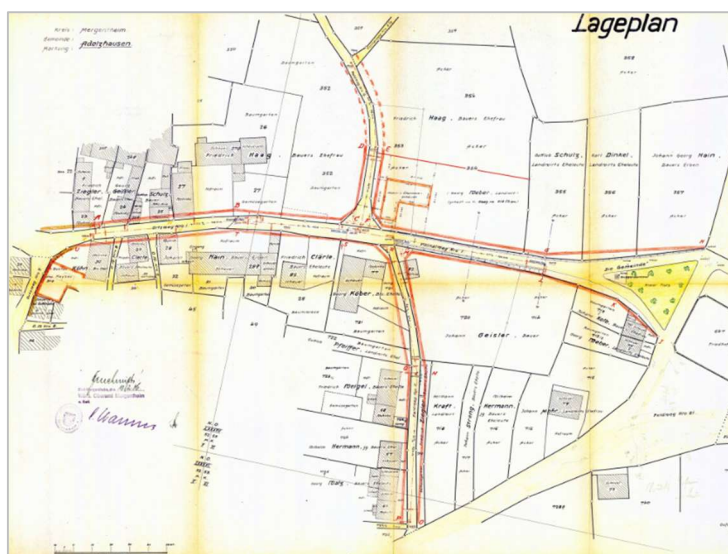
Lageplan Bebauungsplan 'Ortsplan 1936', Quelle: GistBB
